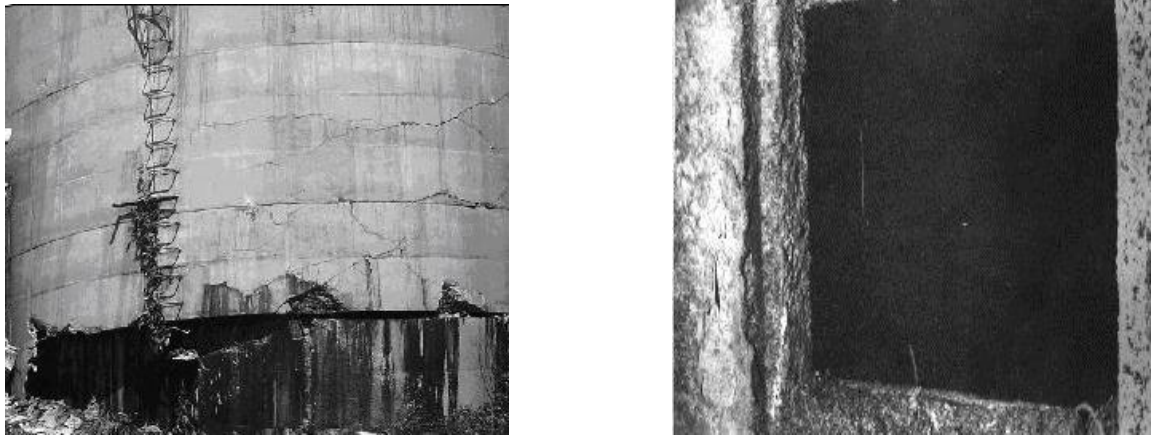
Dégradation d'un silo en béton suite à l'action d'ensilage de maïs (Rylett 2008)
